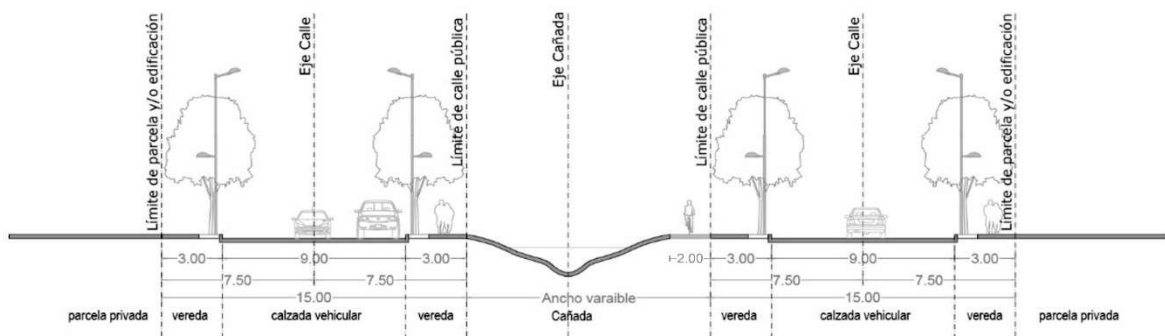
Sección transversal de Vías Especiales Tipo 3.
